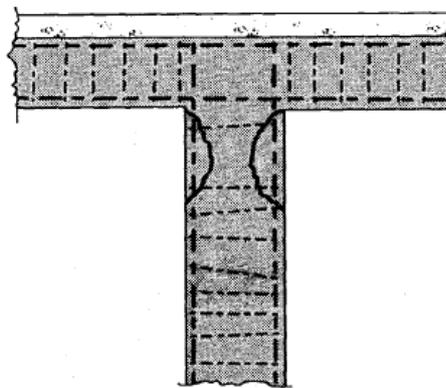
FISURAS POR COMPRESIÓN LOCALIZADA
